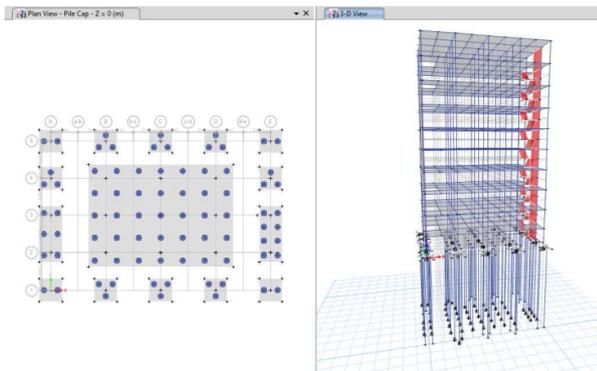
Modeling elemen Pondasi Rakit dan *Pile Cap
